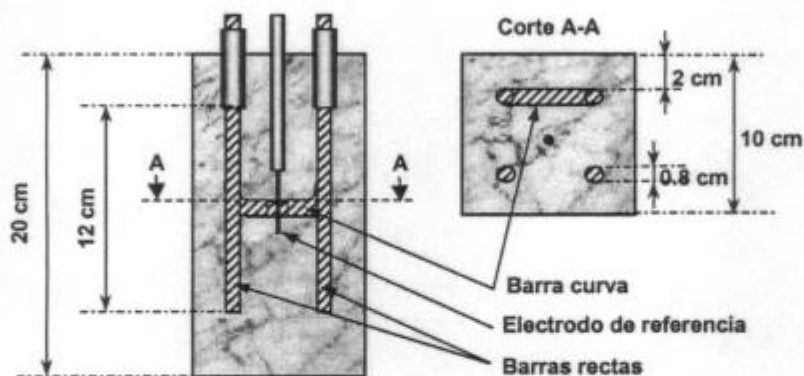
Esquema de las probetas de hormigón con barras de acero empleadas en el estudio.
